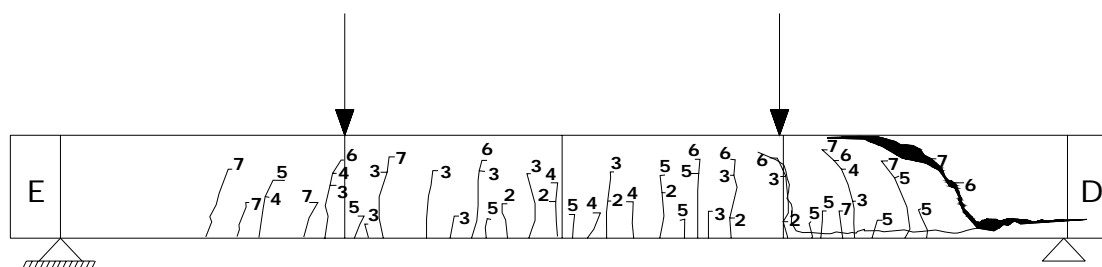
Padrão de fissuração para a viga V90-1 sem armadura transversal
